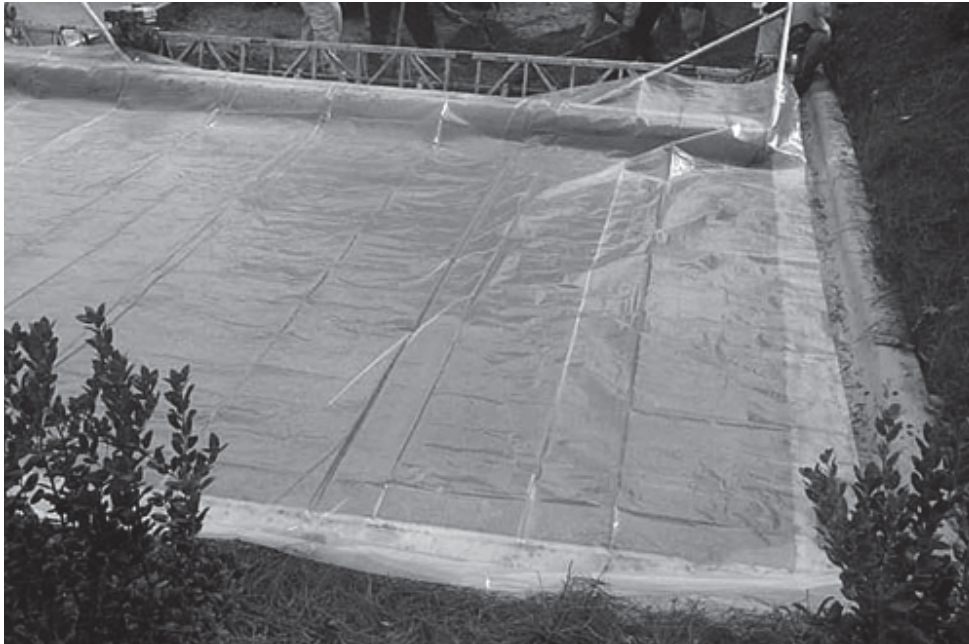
Ejemplo de curado de concreto permeable con polietileno (ACI 522R-06, 2006).
